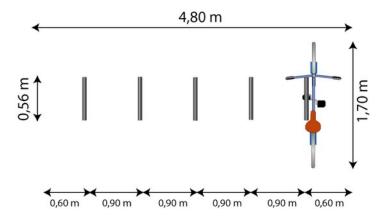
Exemple de stationnement le long d'un mur (rangement perpendiculaire).
